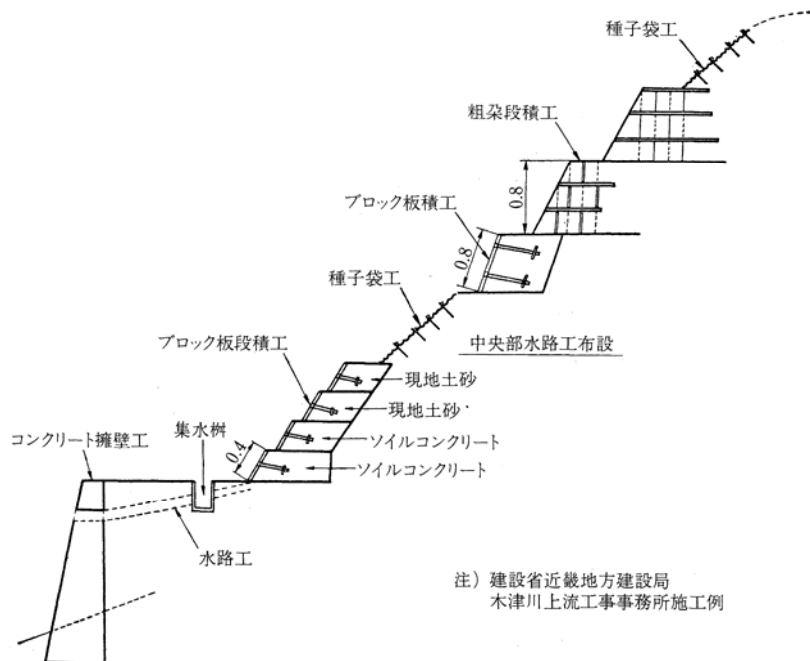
崩壊地（施工例）断面図（単位：m）
